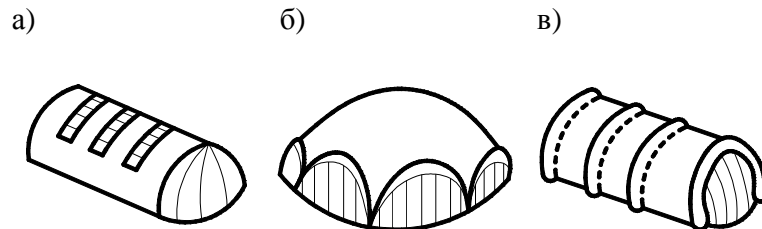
Конструктивно – монтажна схема пневматичних оболонок:
